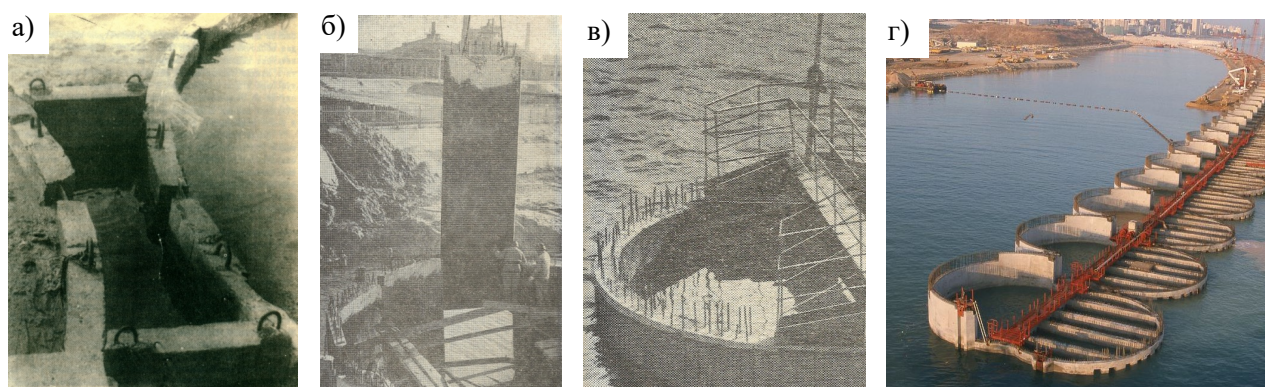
Примеры возведения железобетонных оболочек [147, 229, 301]
